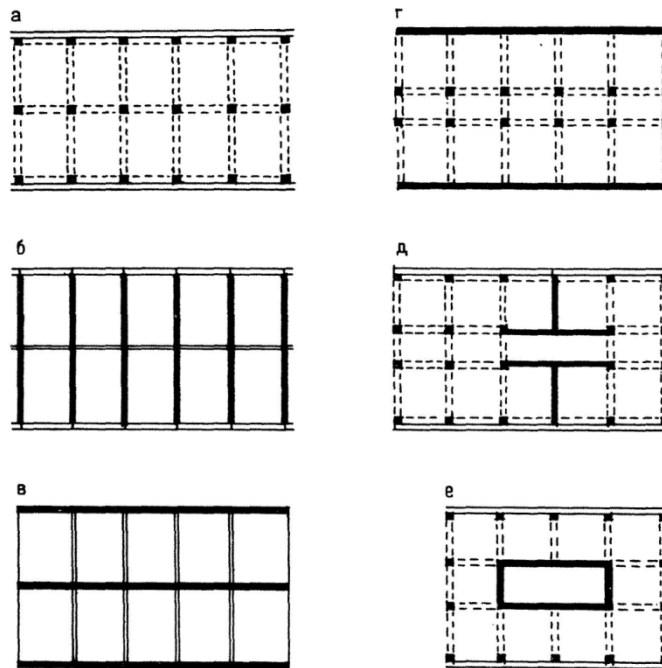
Види несучого остову житлових будинків: а – каркас; б – поперечні несучі стіни; в – повздовжні несучі стіни; г, д, е – комбіновані системи.
